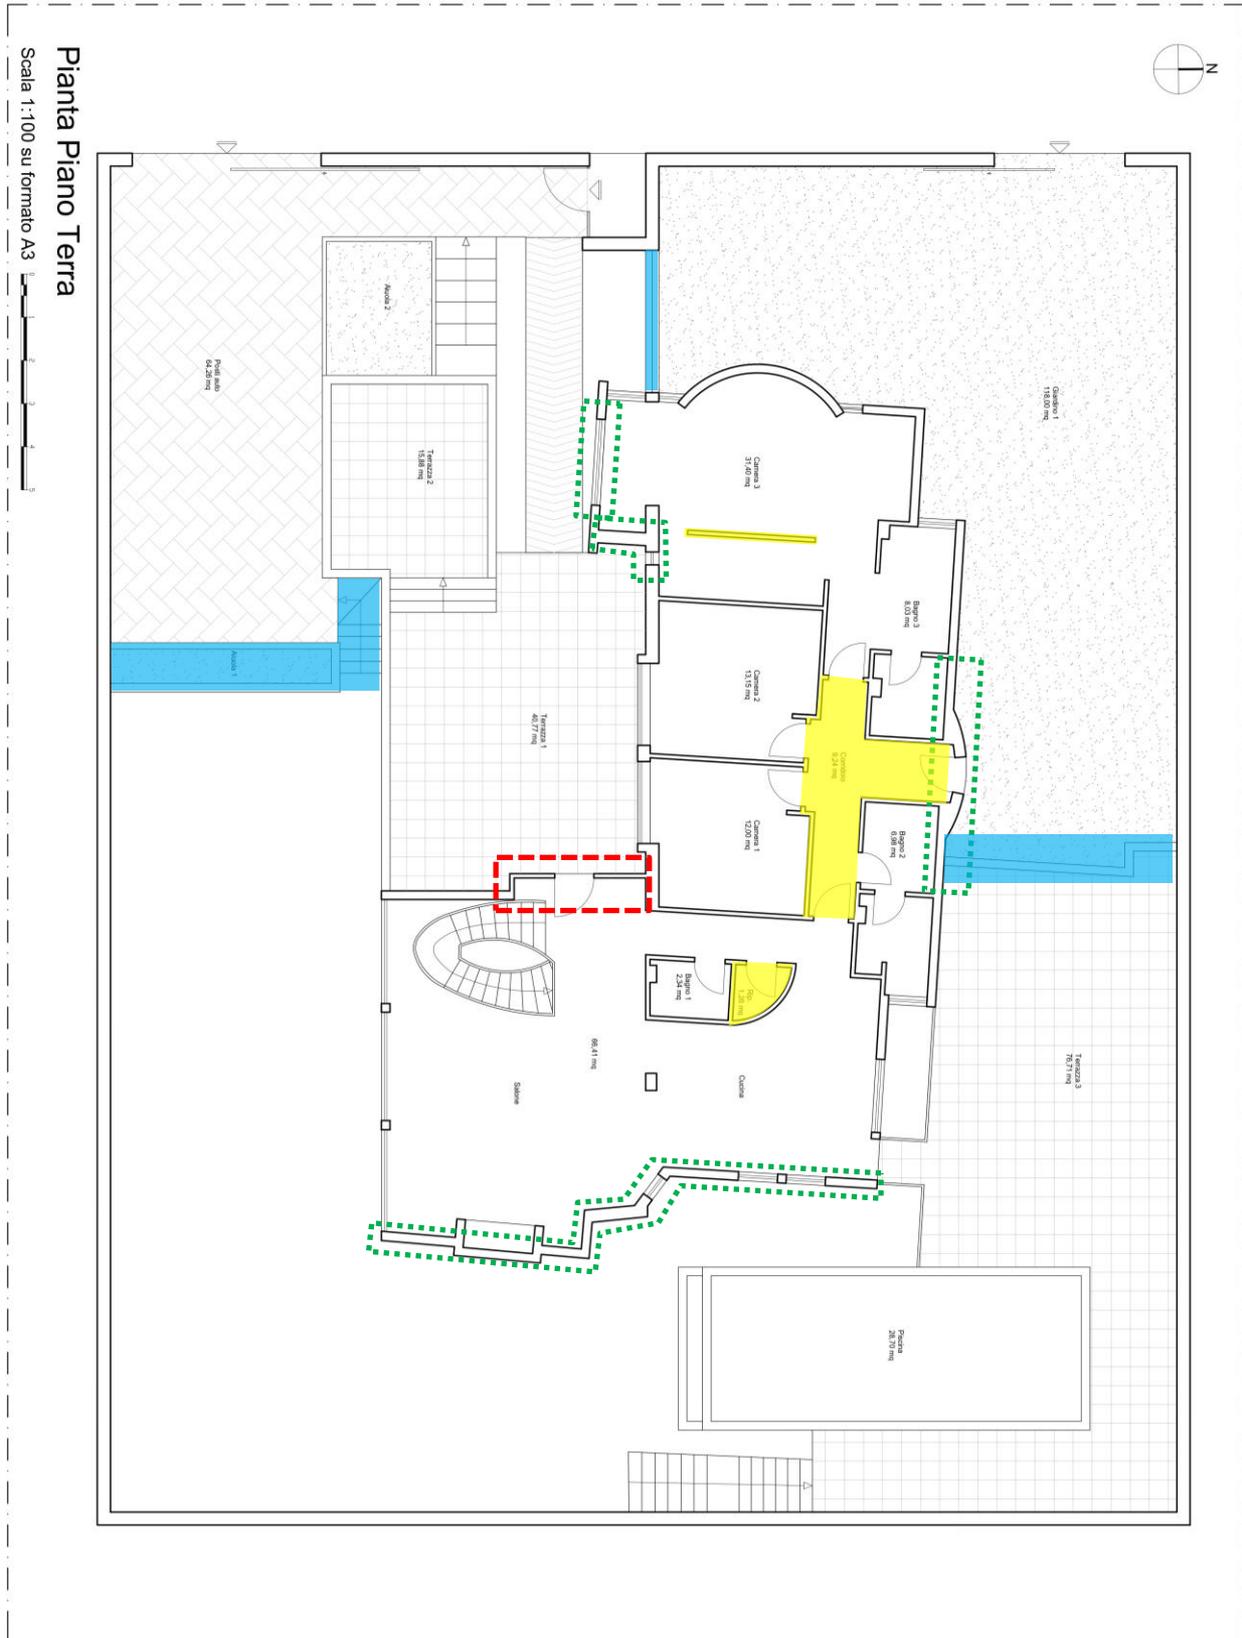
Planimetria stato di fatto con evidenziati gli elementi difformi rispetto a quanto approvato
